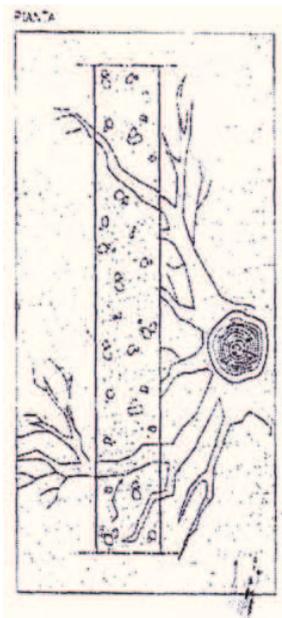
Protezione dell'albero attraverso la dell'irritazione dell'area minima di rispetto in aree parco
